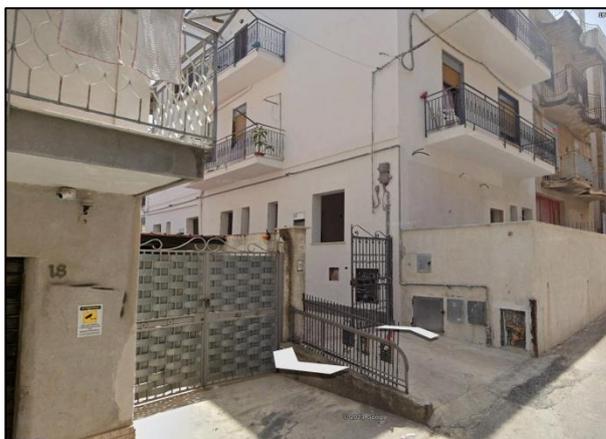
Ingresso civ. 20 (fonte Google earth)
